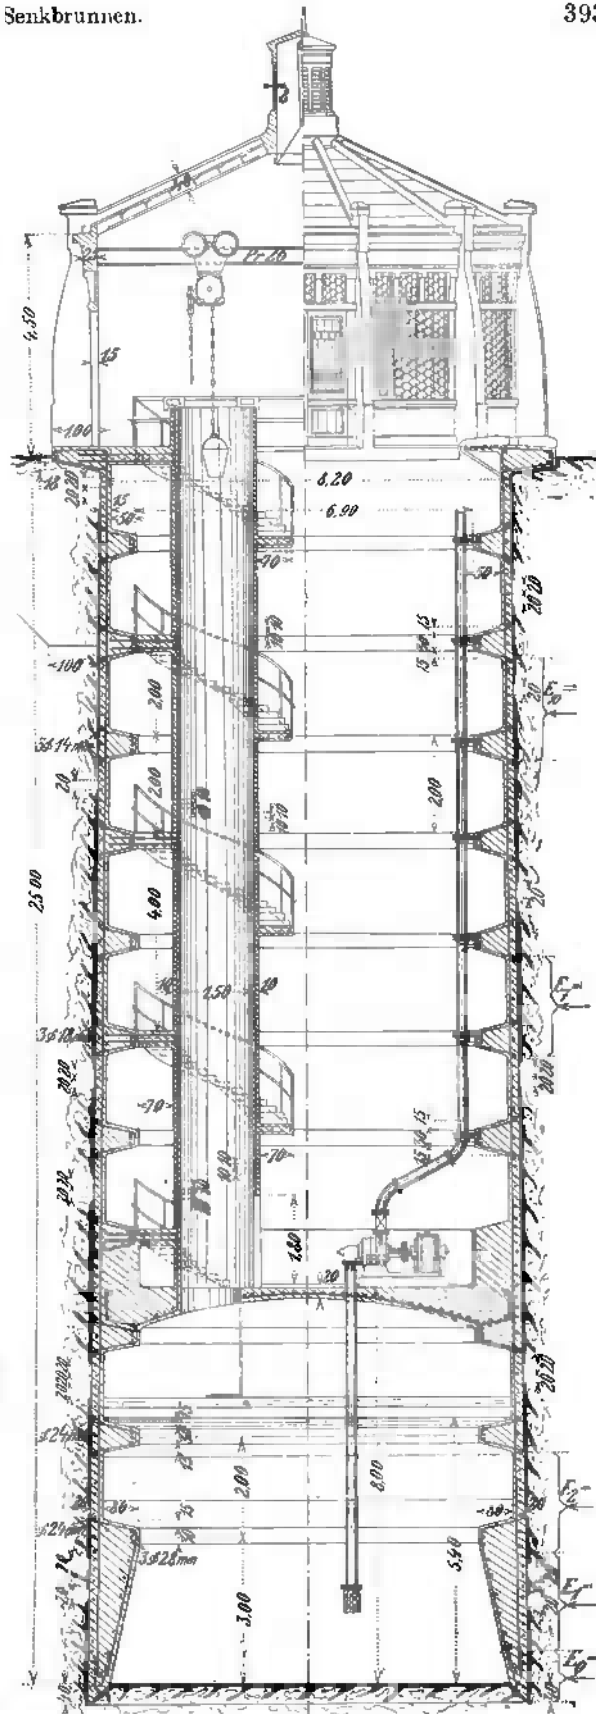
Schachtbrunnen aus Eisenbeton für die Brauerei Reininghaus. (Aus Handbuch für Eisenbetonbau Bd. VII.)
